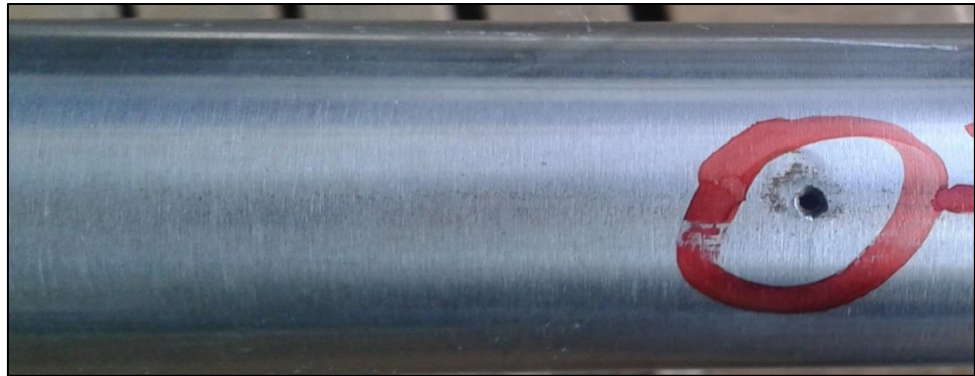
Tubería Horizontal con Picadura Tramo 2
